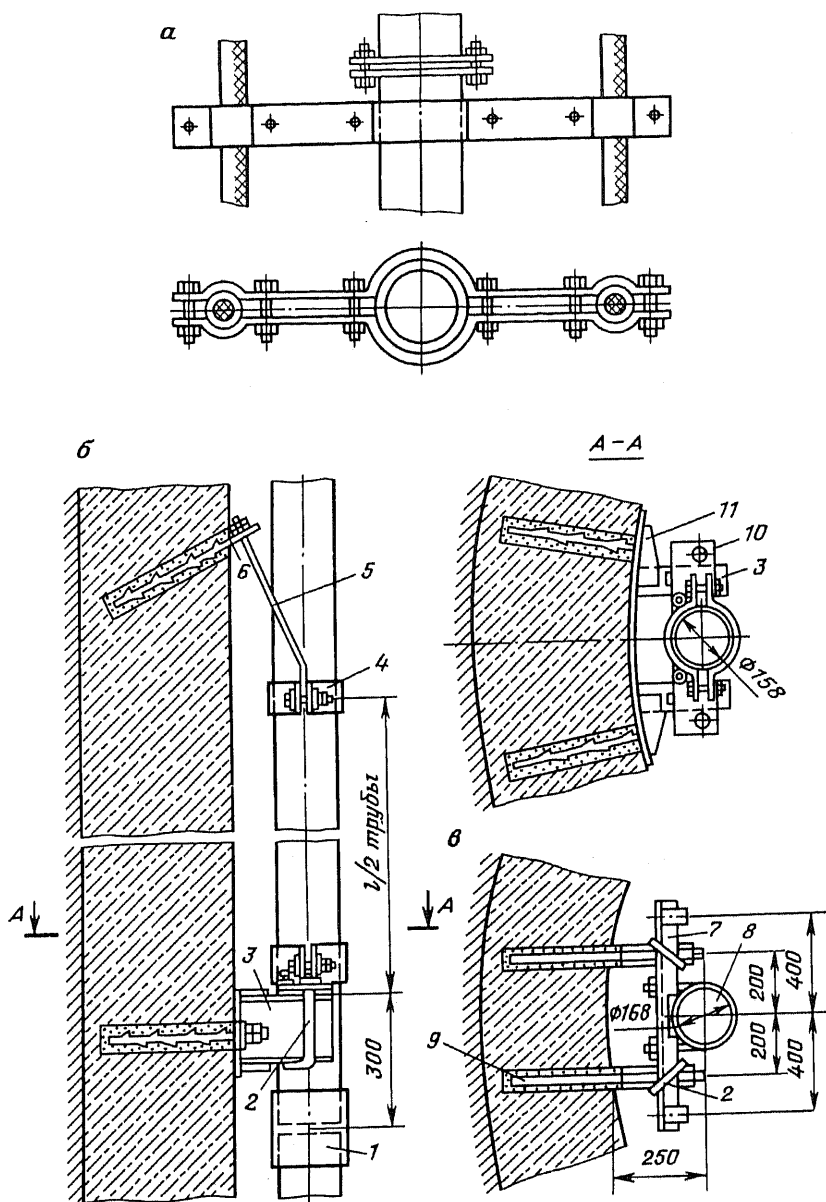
Схемы подвески бетонопровода в стволе:
